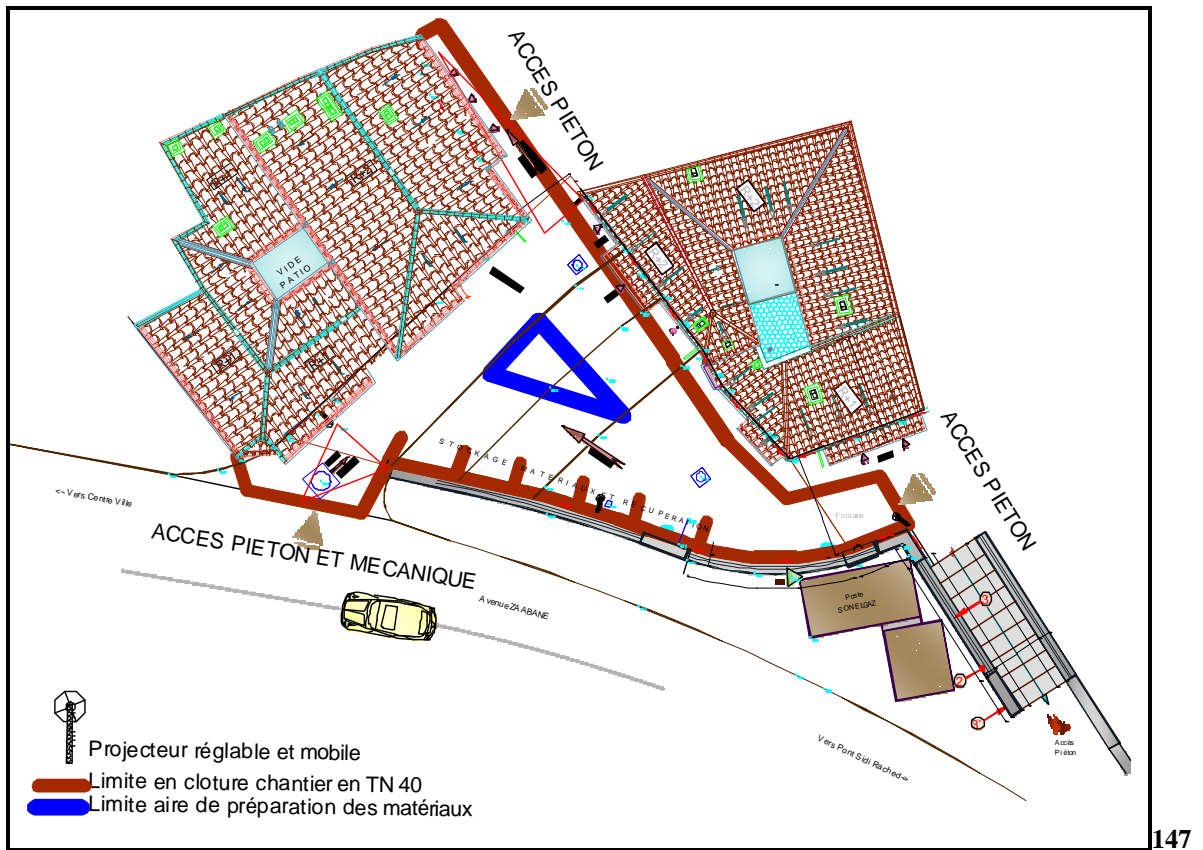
Plan d'installation de chantier des travaux sur la maison 12.
